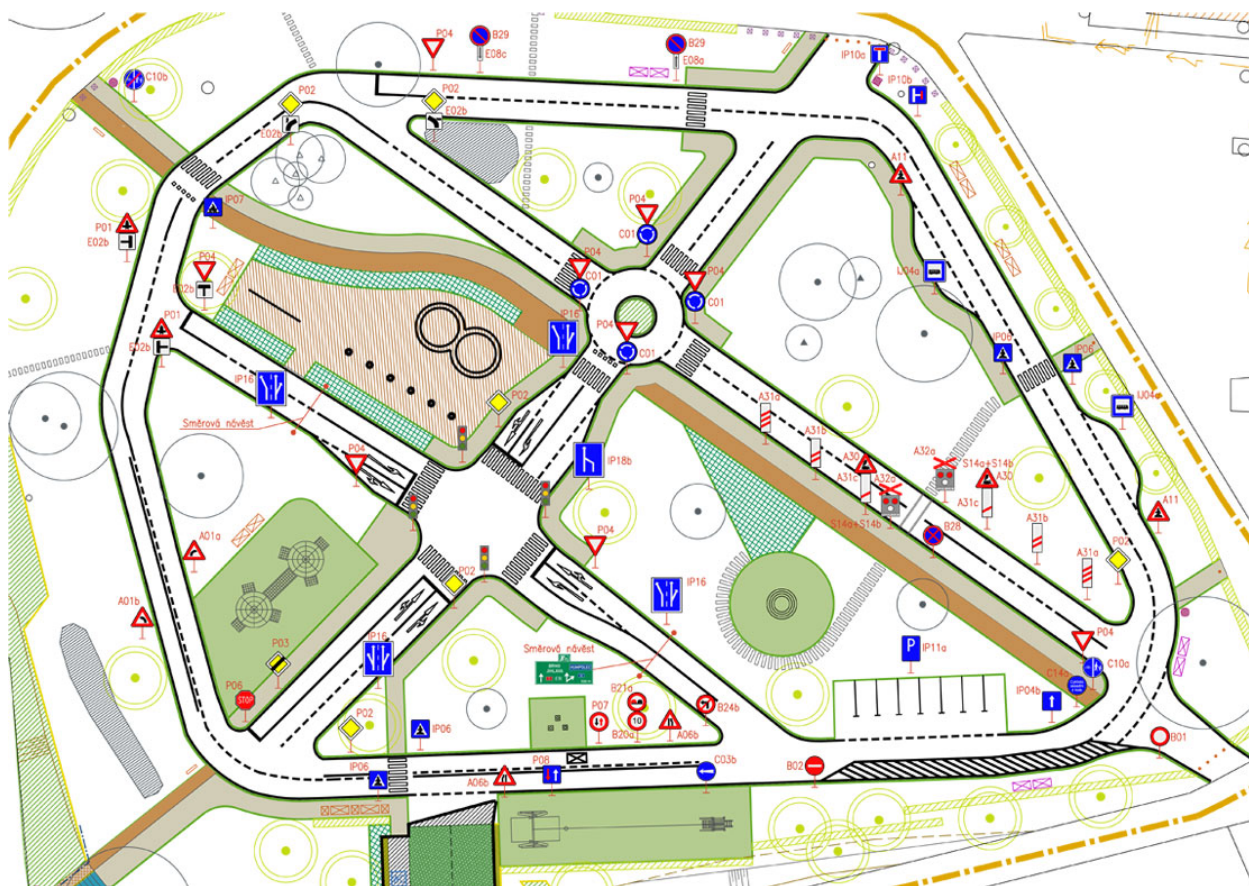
Plán dětského dopravního hřiště Mladá Boleslav
